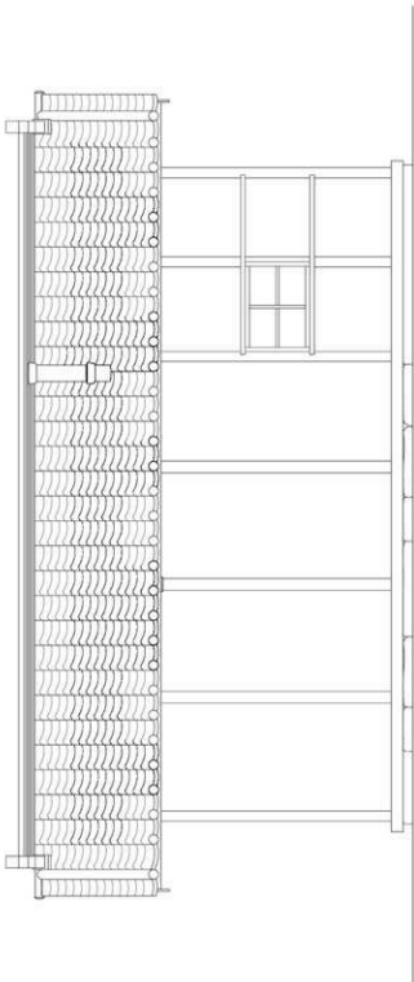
梁屋 竣工 東立面図 $S=1/50$
